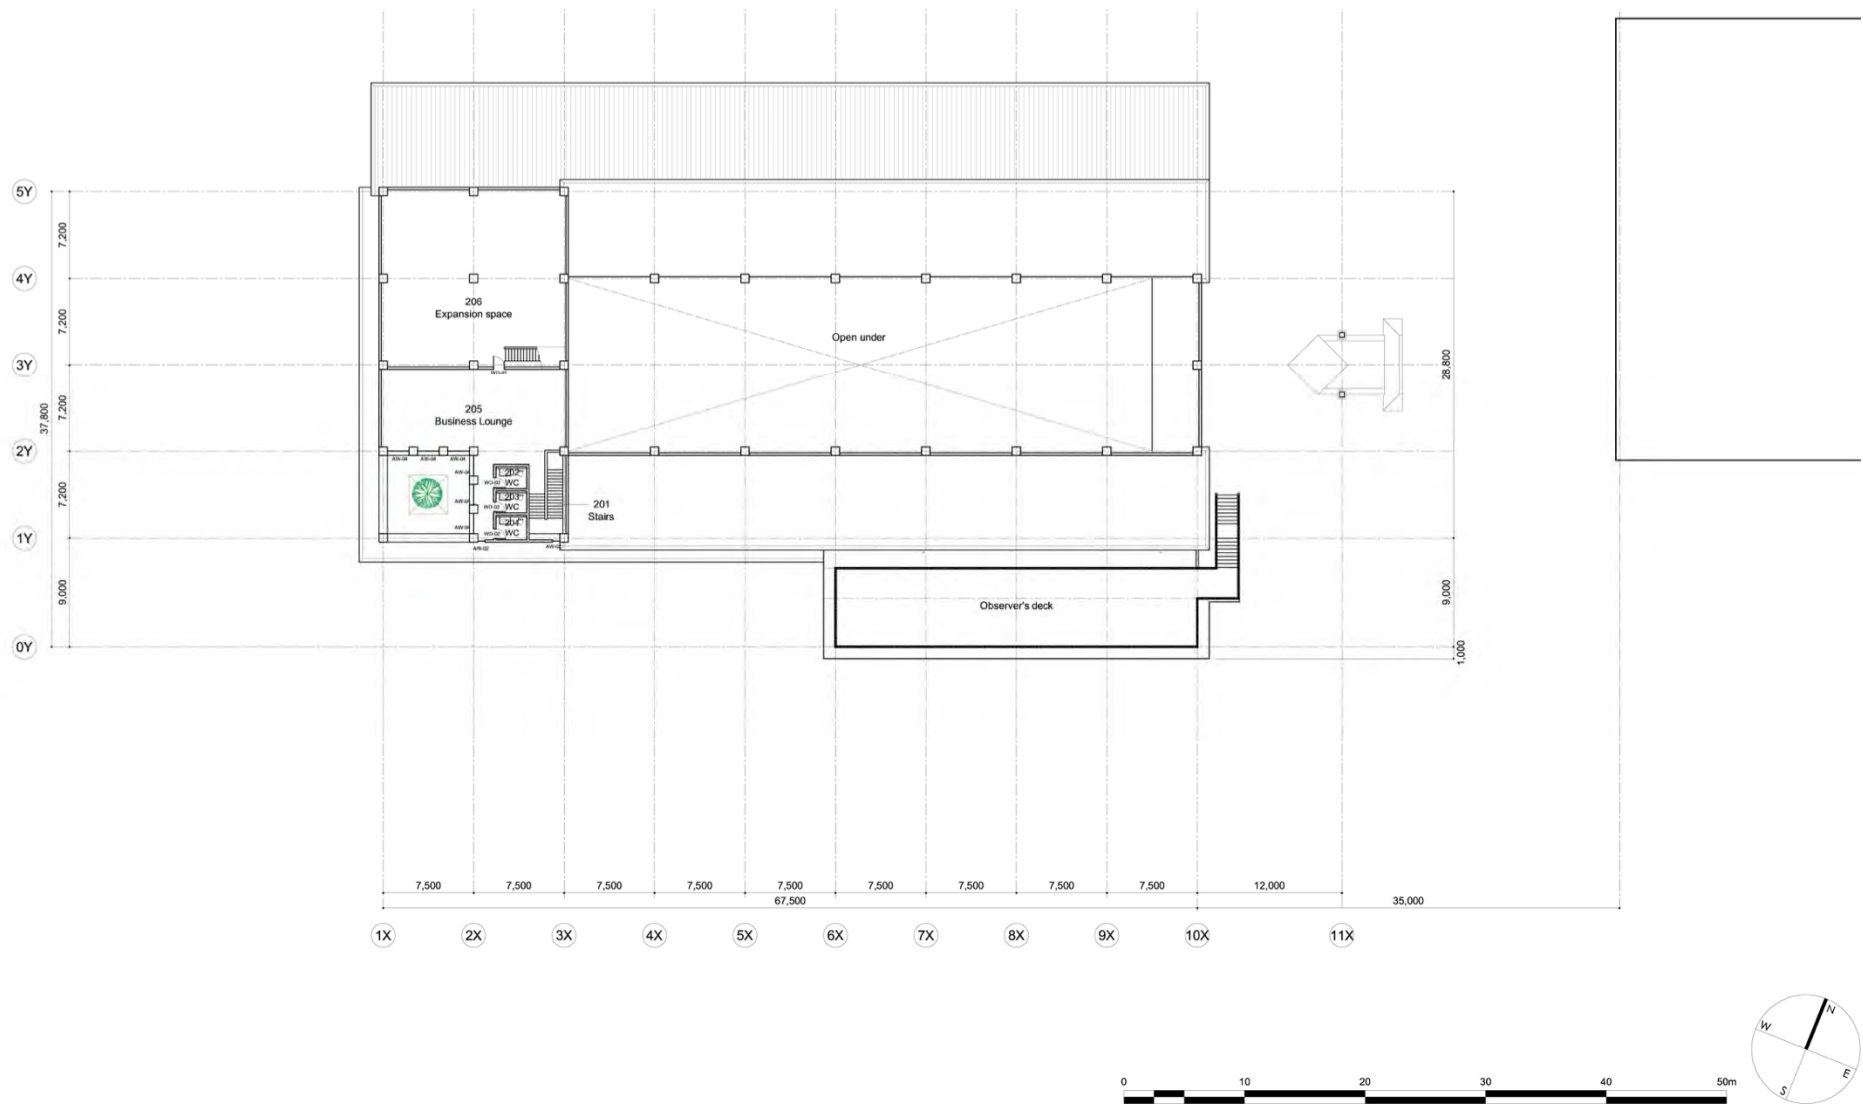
国際線出発ターミナルビル (IDT) 2 階平面図
